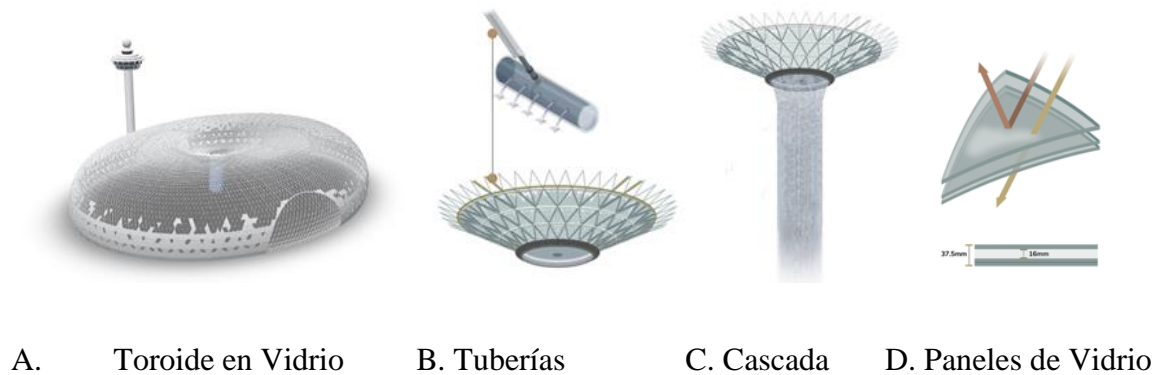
Sistema Estructural Edificio La Joya Aeropuerto de Changui
